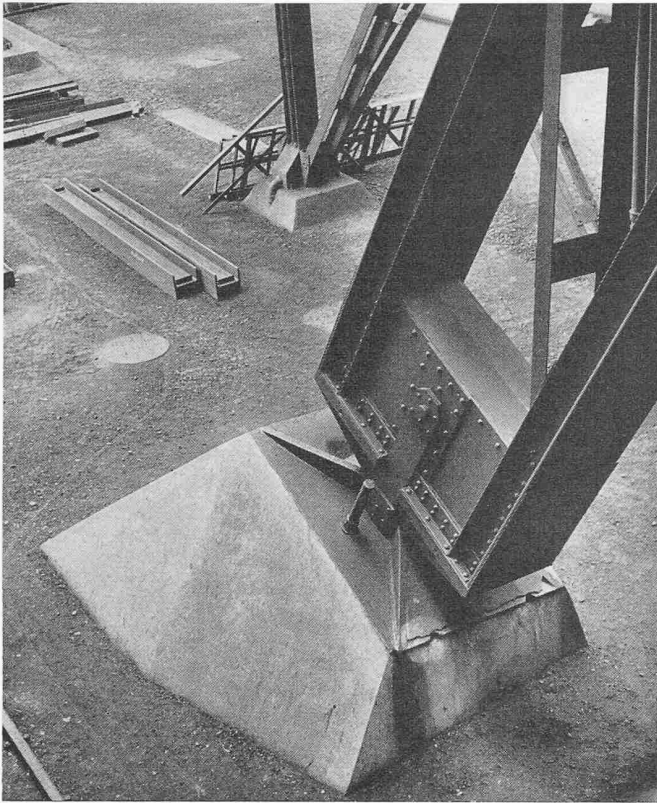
Trägerfundament in einem besonders aggressiven Boden aus Beton mit Tonerde-Schmelzzement
